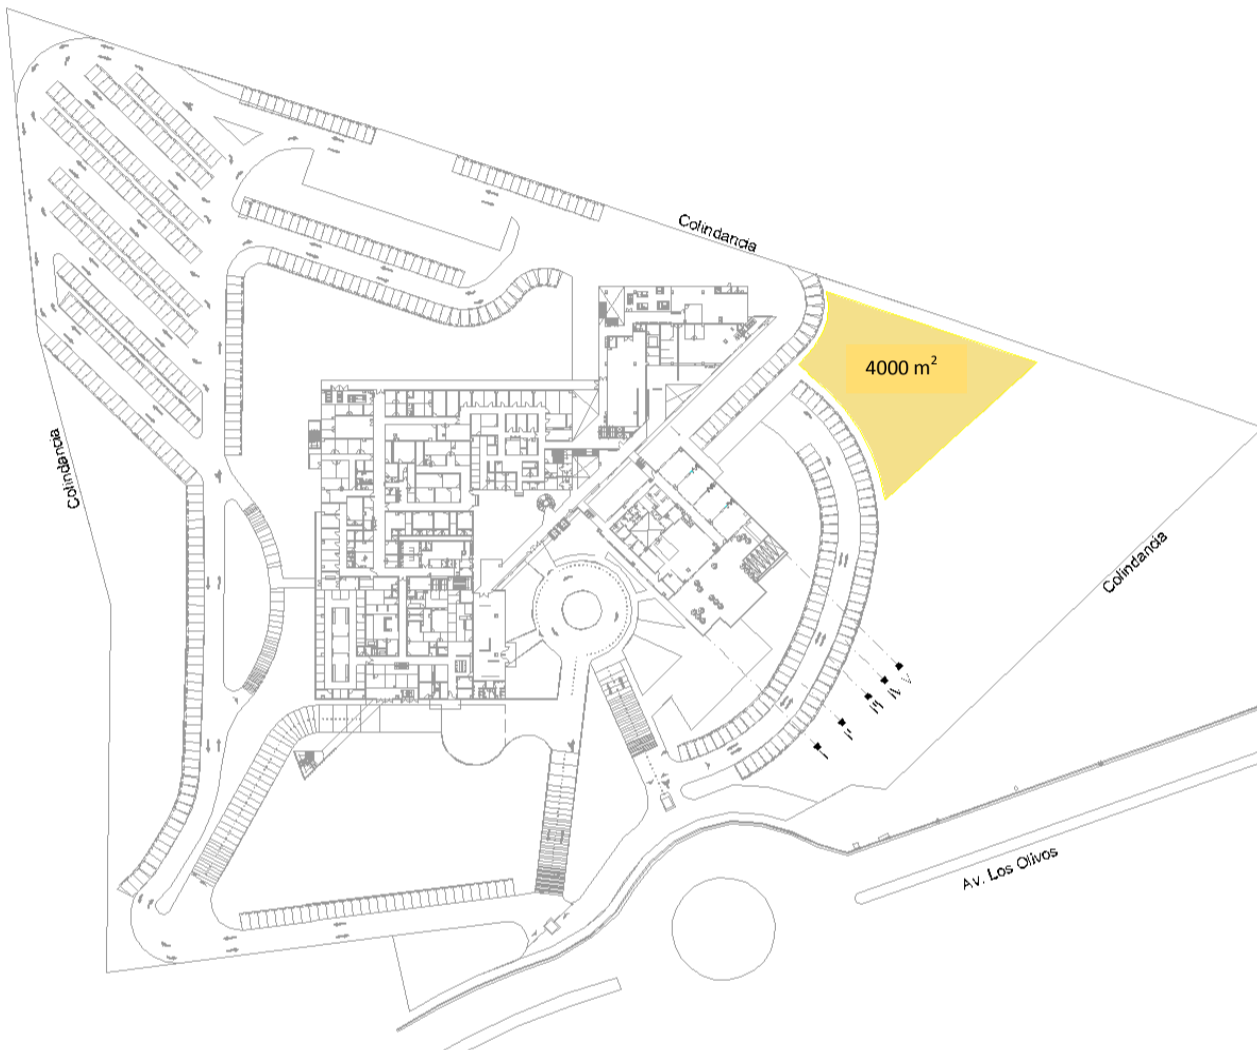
4 Localización del predio dentro de la planta general del HGR1 IMSS, Dpto. Construcciones
